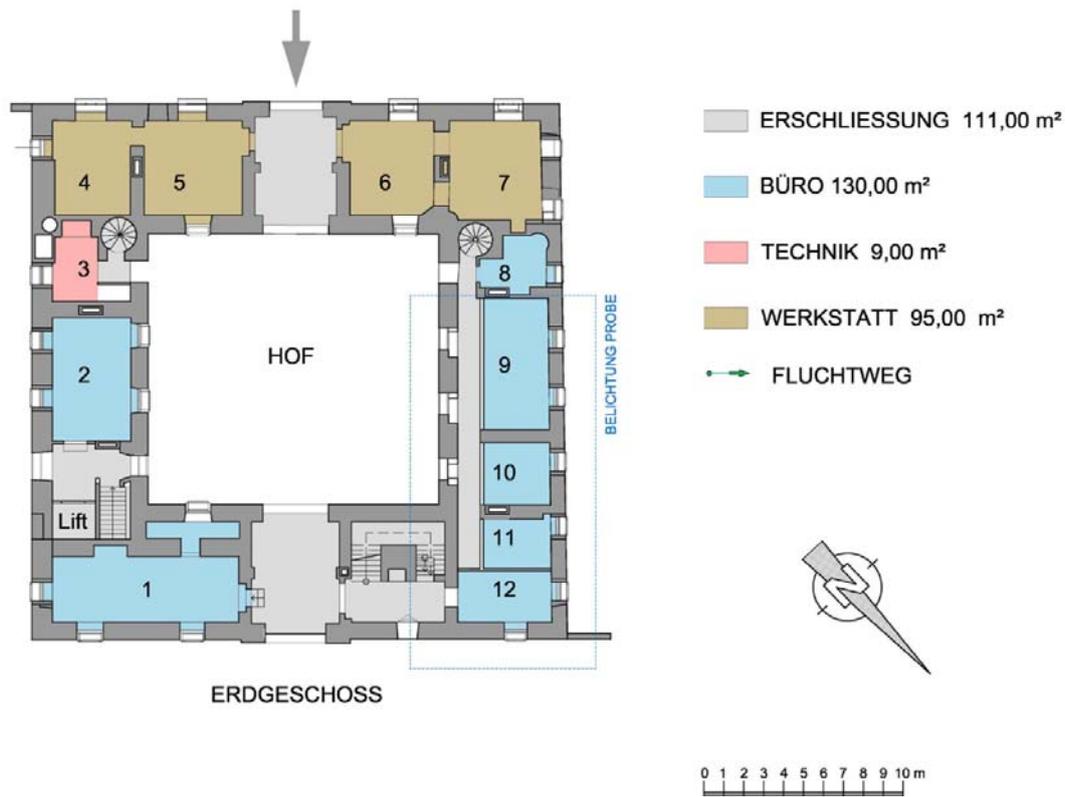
zeigt den Grundriss des Schlosses Raggendorf
